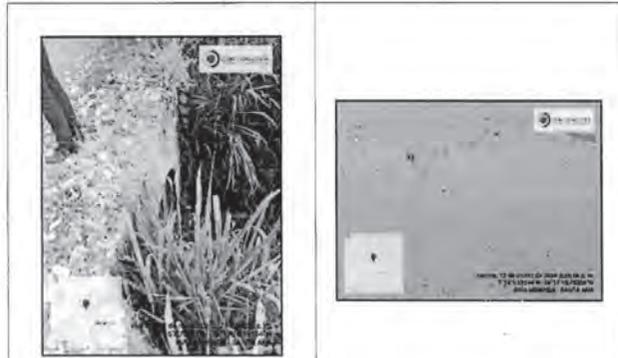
Tubería de paso o pequeño boxculvert, elaborado por los ingenios azucareros.
